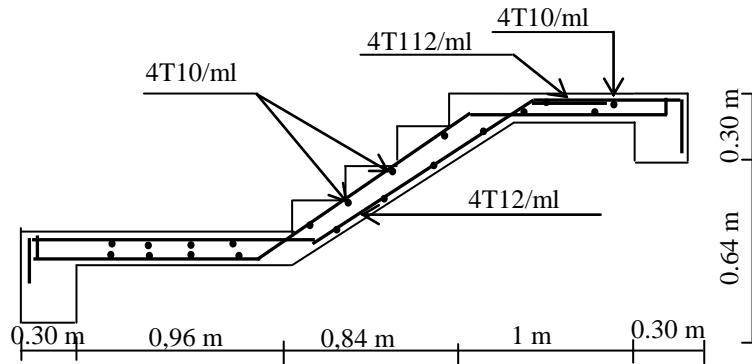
Schéma de ferrailage de l'escalier type 2.
